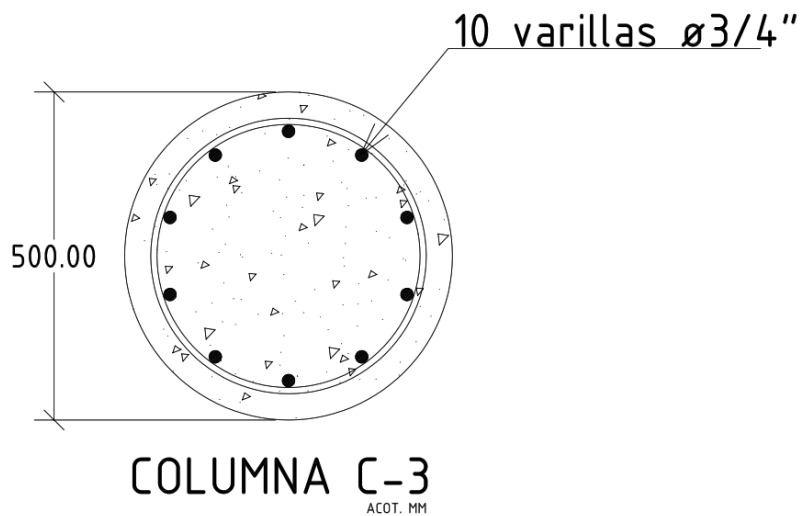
Vista esquemática de la sección. (Fuente autoría propia, 2019)
